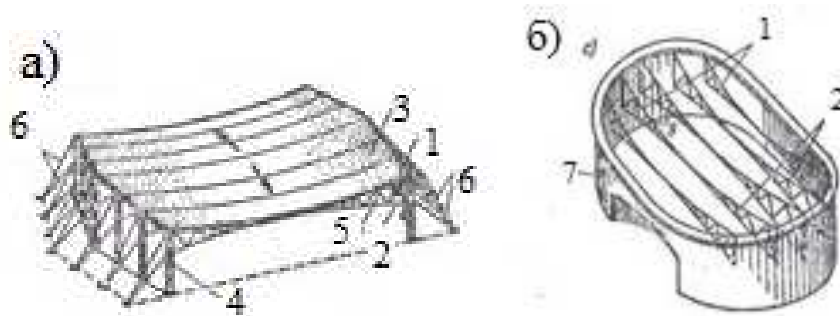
Покрытия с параллельно расположенными тросовыми фермами системы инженера Д. Яверта:
